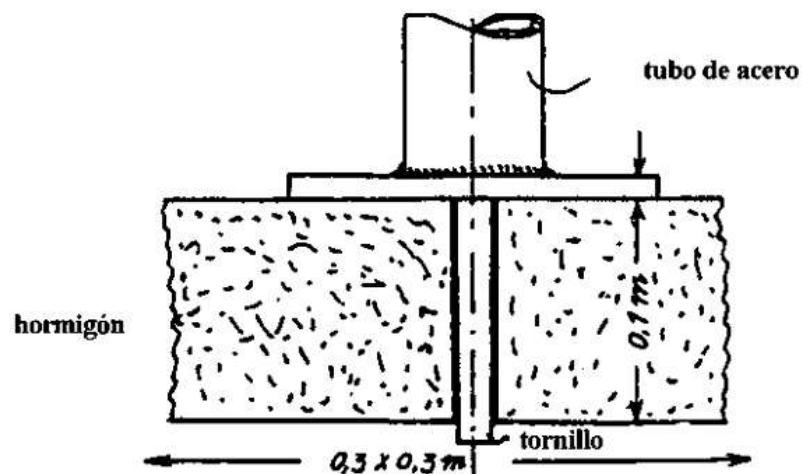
Cimentación de tubo de acero en zapata de hormigón
